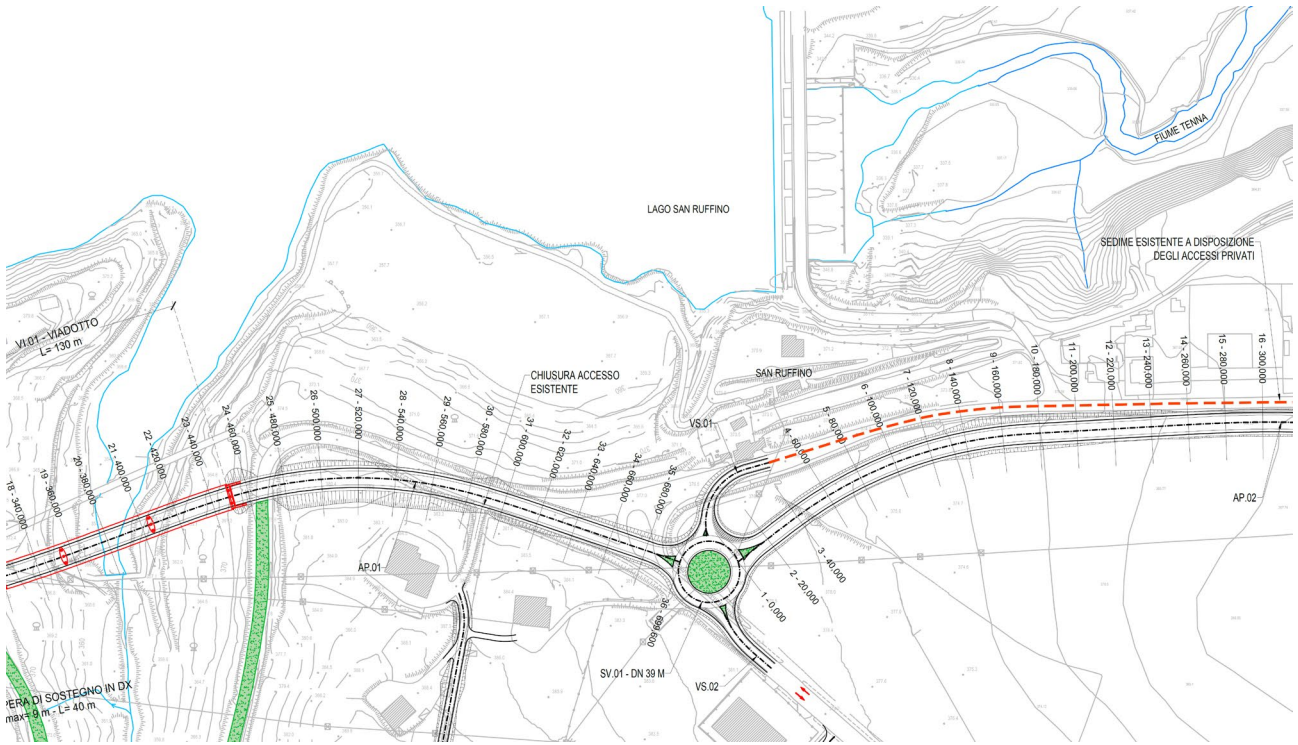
Planimetria del secondo tratto con la rotatoria che raccorda la sede attuale lasciata a servizio degli edifici
